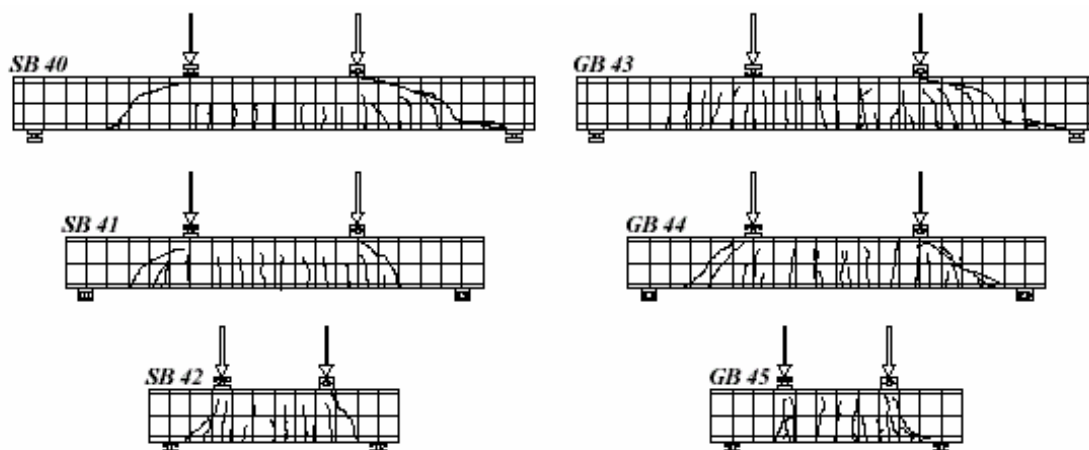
Panorama de fissuração das vigas (GUADAGNINI *et al.*, 2001).
